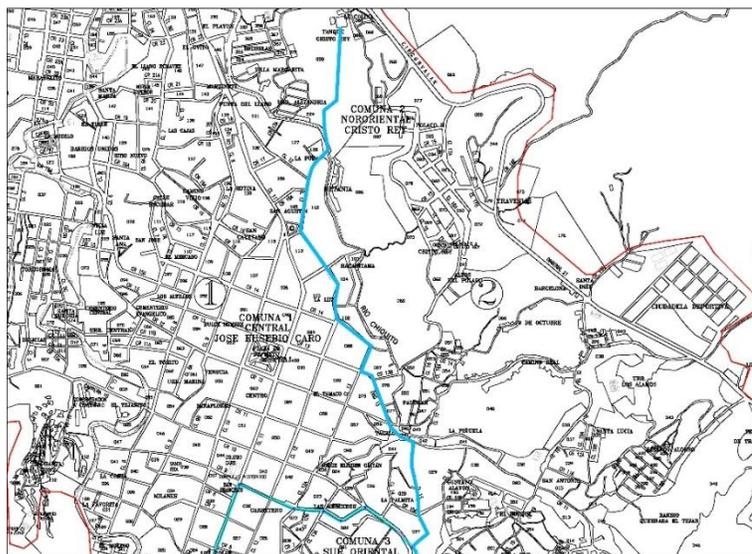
Localización en planta de la tubería de conducción bifurcación denominado San Cayetano- tanque Cristo Rey. Fuente: Pasante del proyecto.
